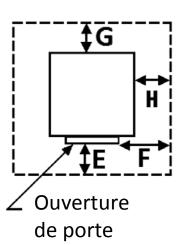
Protection de plancher équivalent, approuvé comme protection de plancher.
